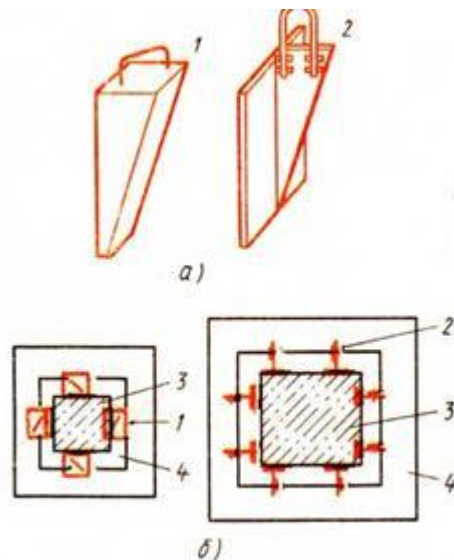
Кріплення колони клинами: а) клини, б) кріплення колони клинами у фундаменті
